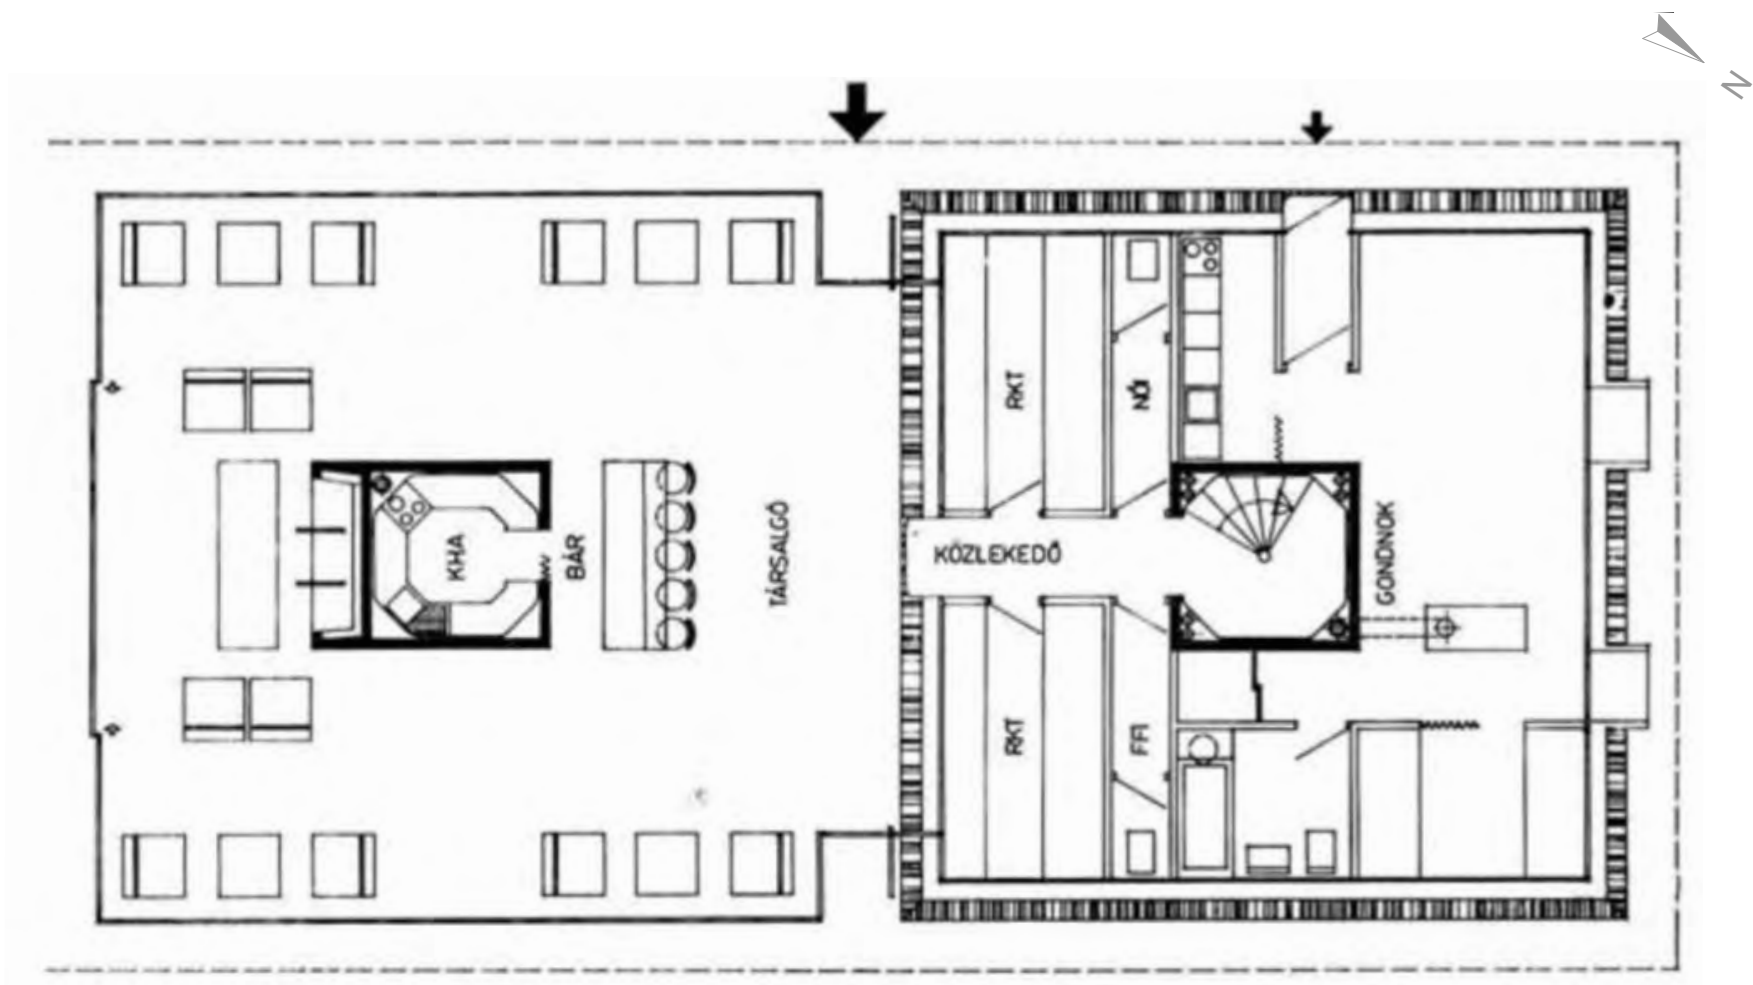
Grundriss von dem Erdgeschoss vom Virág
